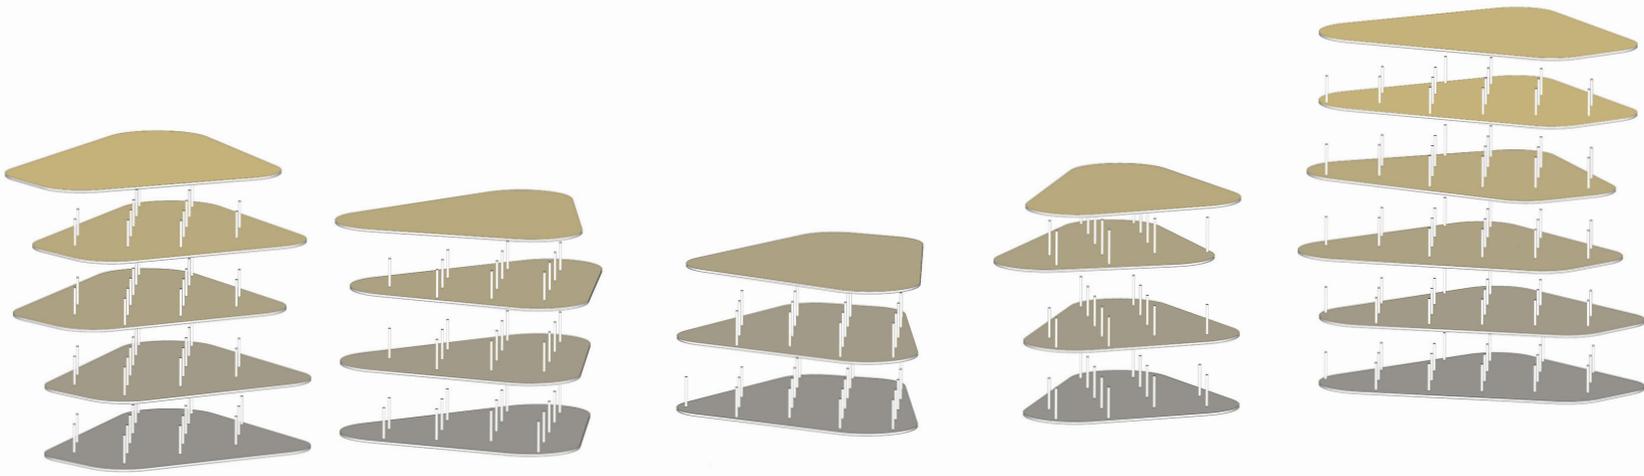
| Tragsystem, Stahlbetondecke mit Stahlbetonstützen
